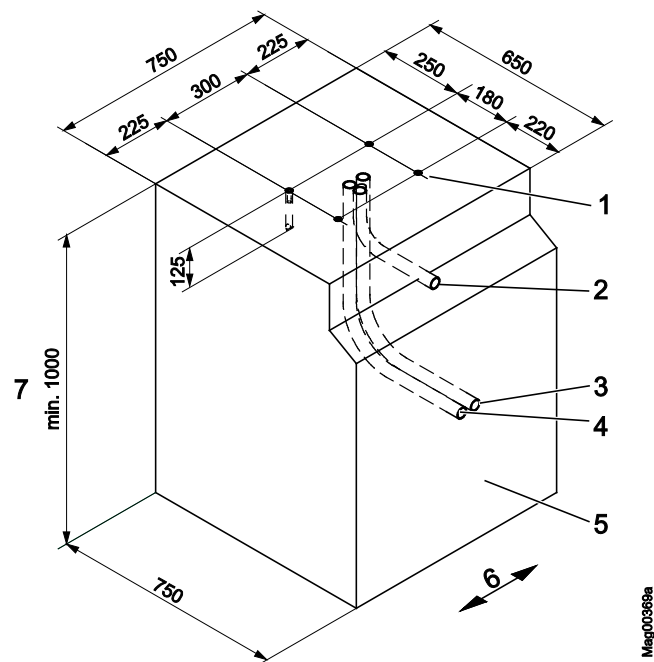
Fundamentschema Access XL2 och Access XXL (mått i mm)
